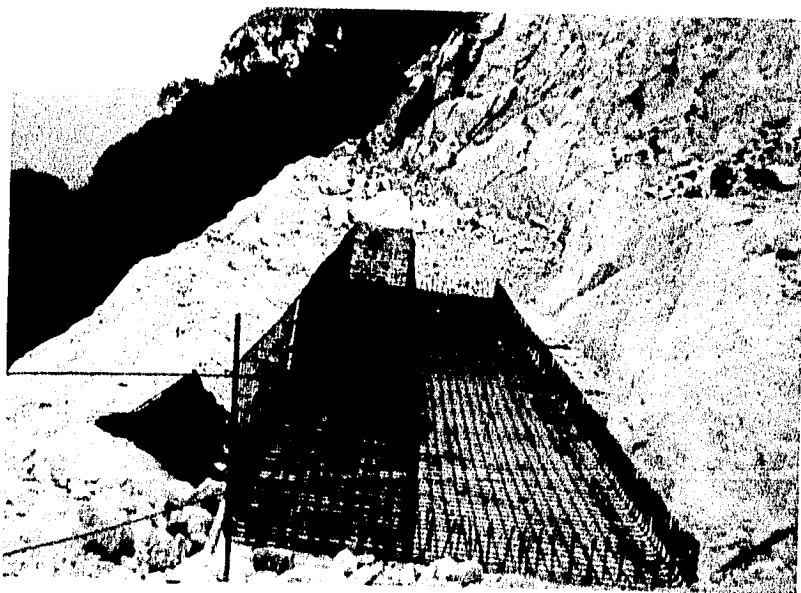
Detalle de armado del acero de refuerzo en Estribo No. 4.
